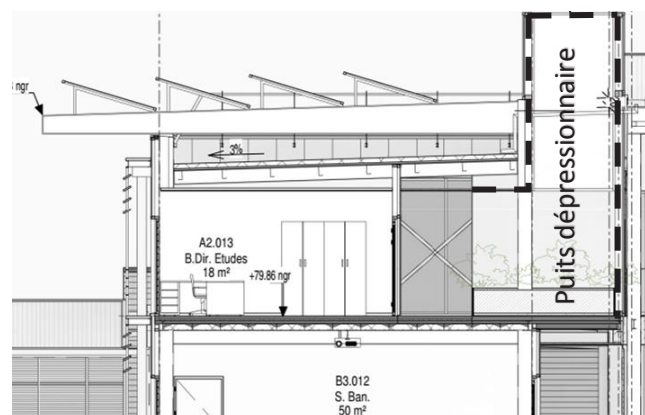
coupe BB sur puits dépressionnaire (bâtiment D)
